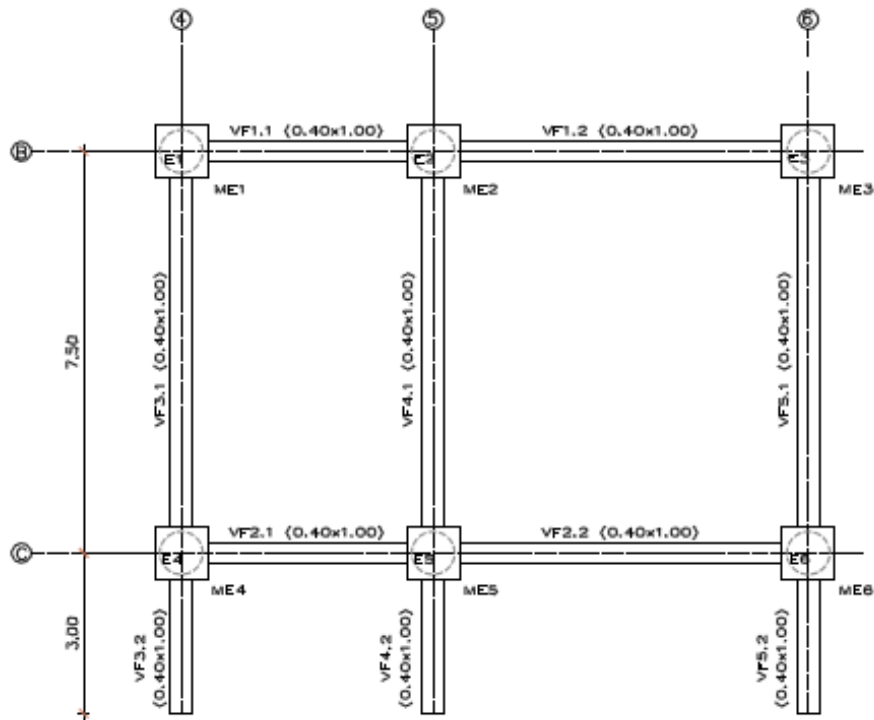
Planta com a Geometria das Vigas de Fundação.
